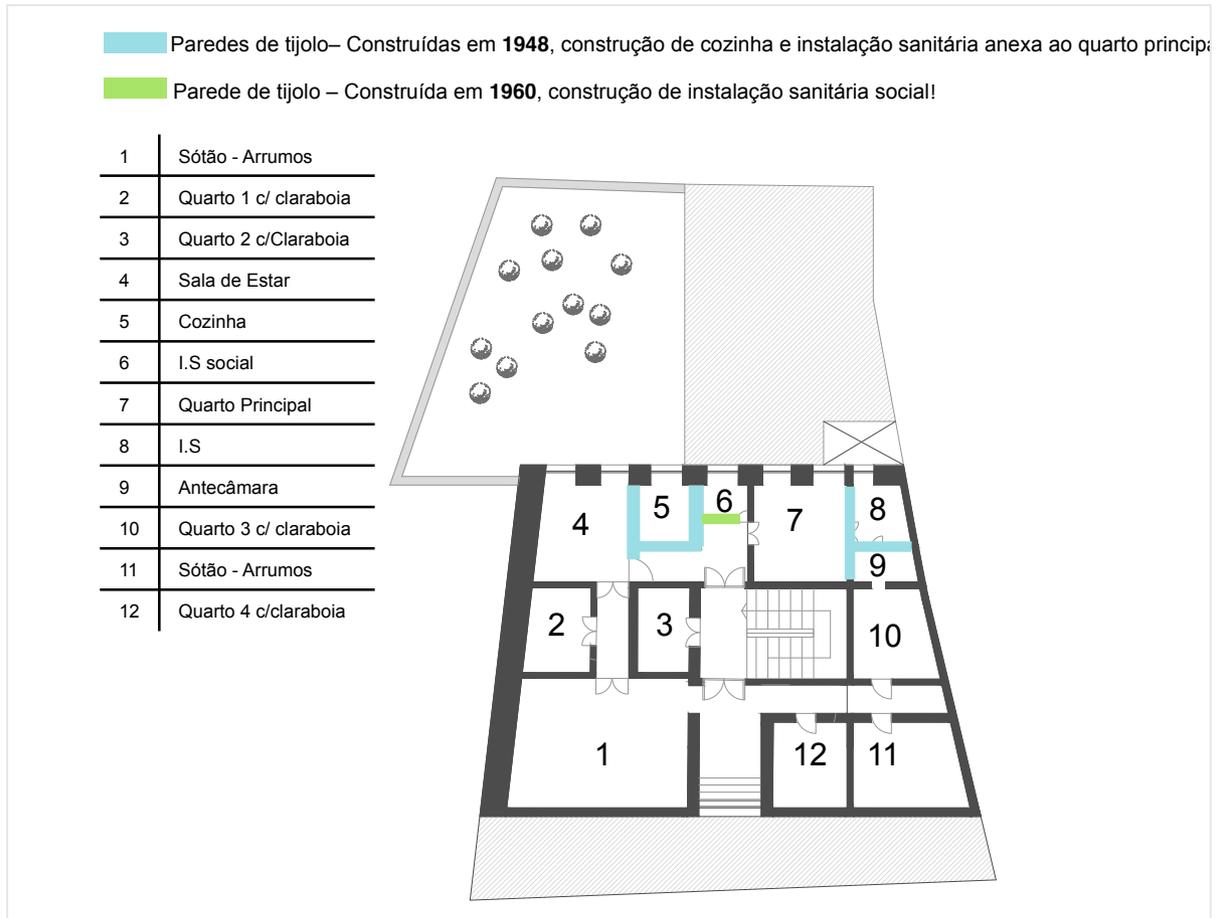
Planta piso 2 – Sótão Casa particular (Beatriz Ramos de Matos – desenhadas em 2017 demonstração das alterações construtivas ao nível do interior do edifício).
